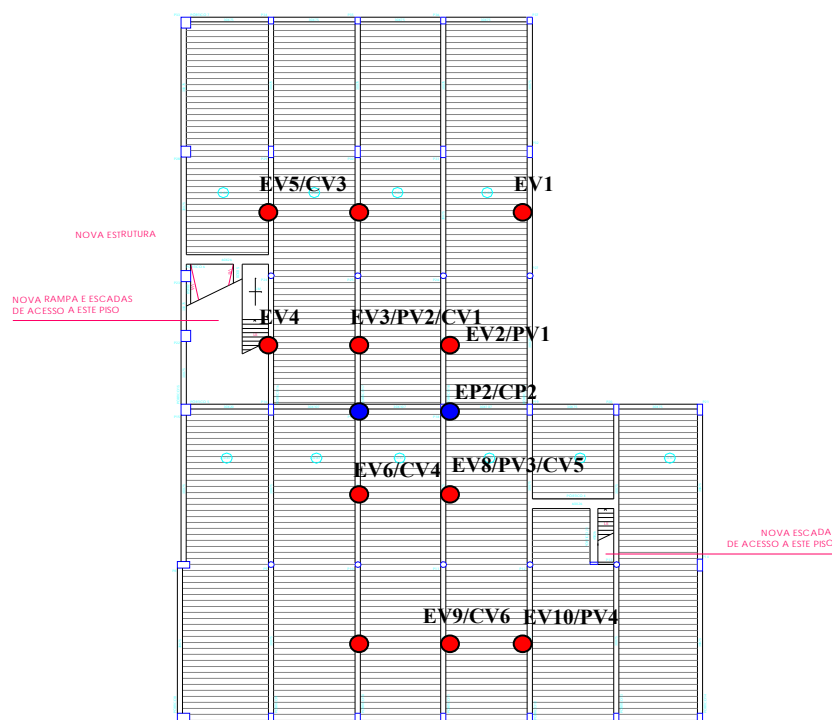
Planta estrutural e identificação dos pórticos.
